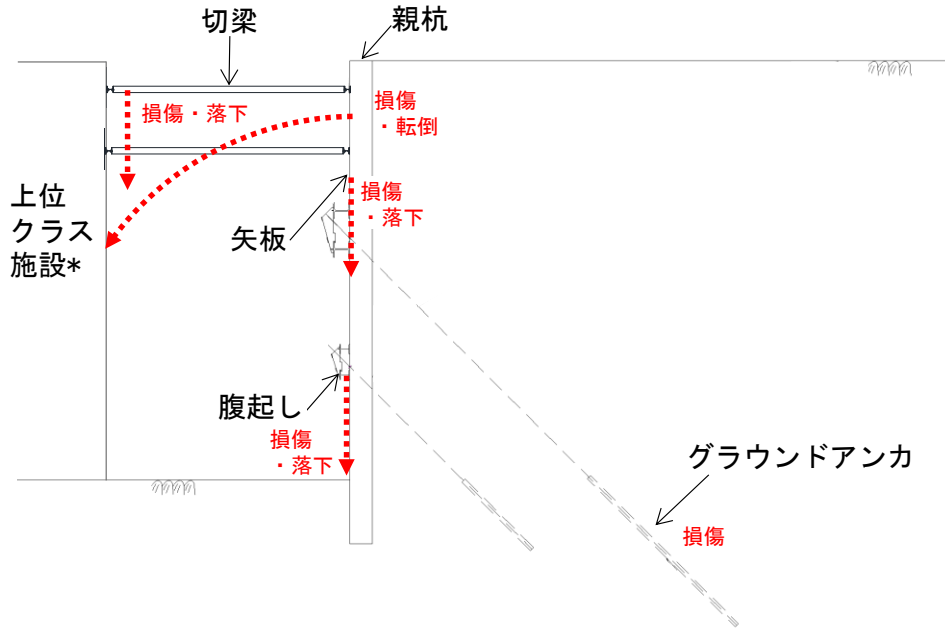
(5) 土留め工 (親杭) 概略断面図 (⑤-⑤' 断面)
